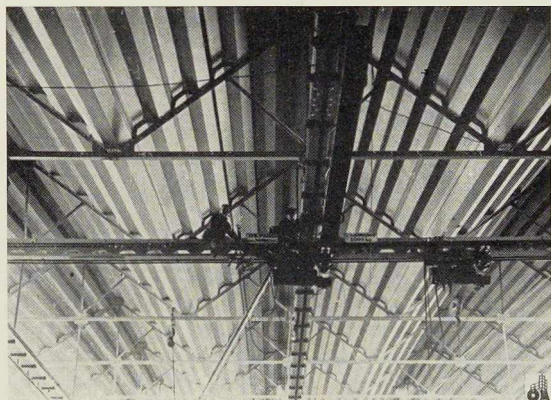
Coupe du toit doublement ondulé du hall « Stahl und Eisen ».
